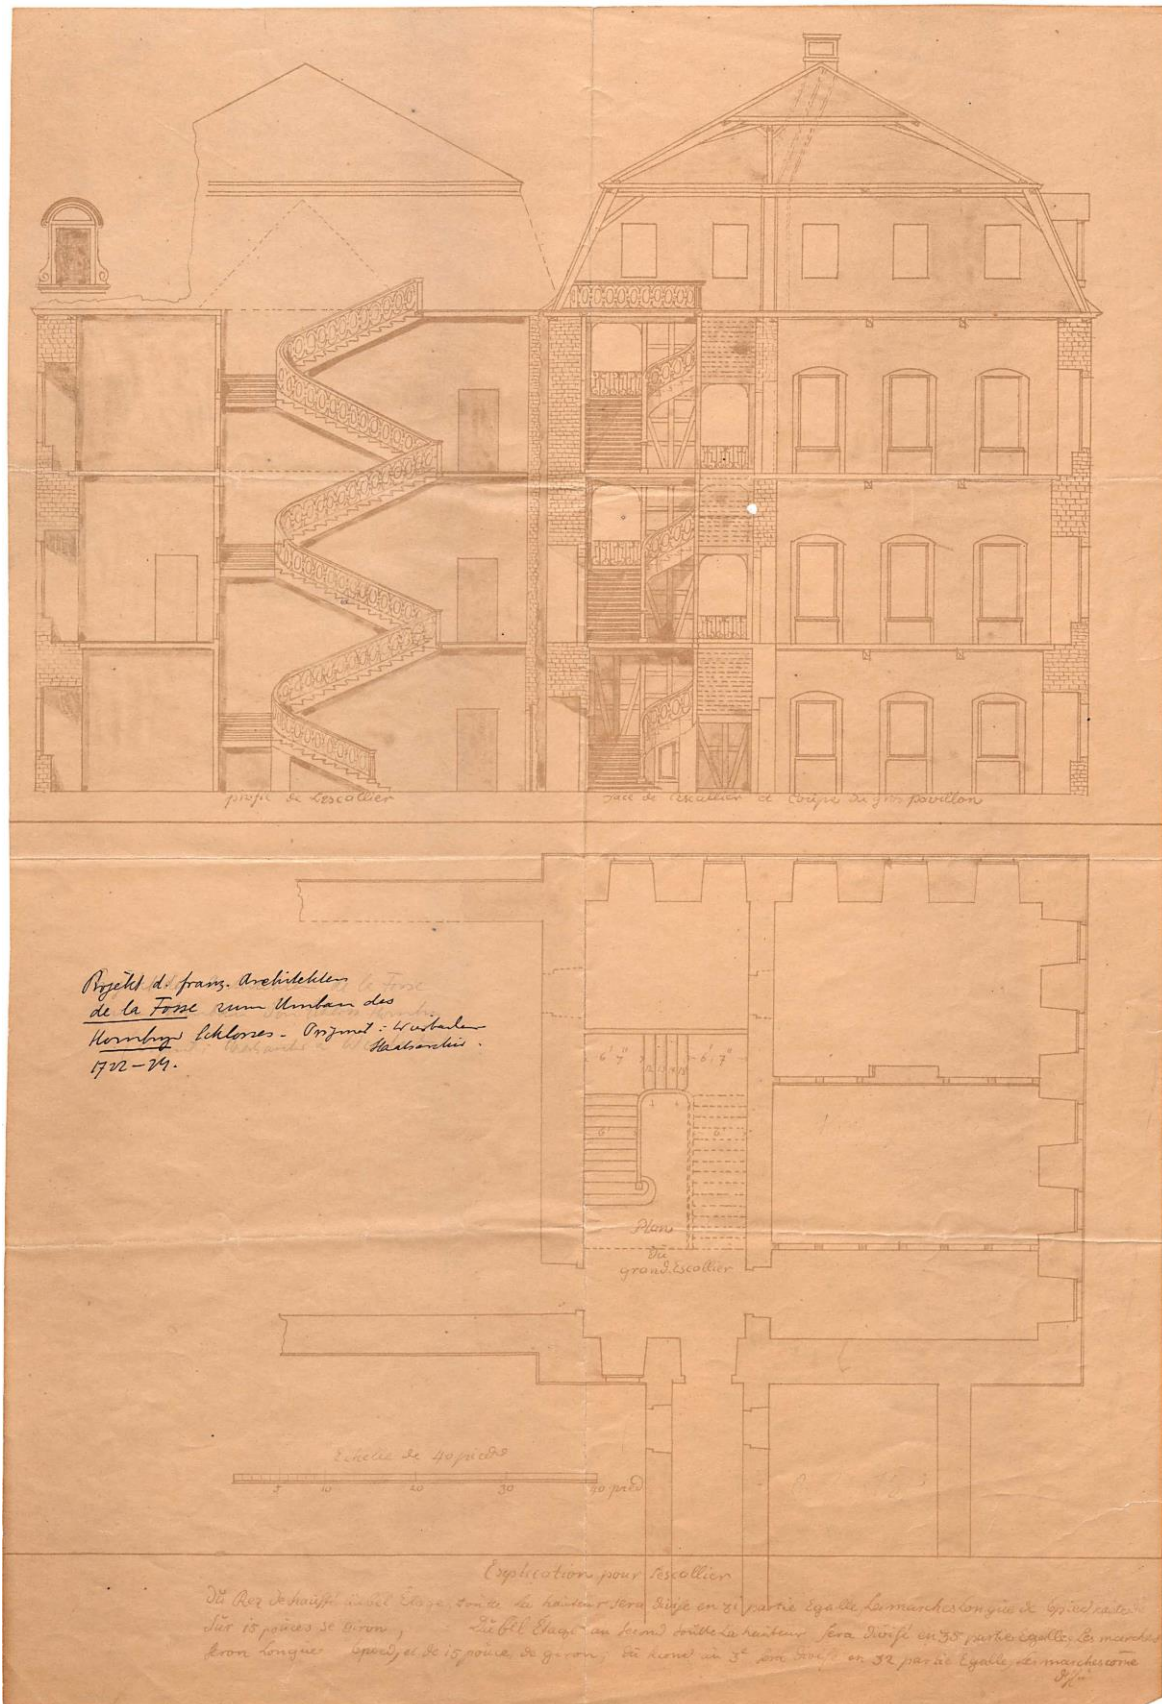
„Projekt des franz. Architekten de la Fosse zum Umbau des Homburger Schlosses. 1722-24“ „Eseptecation pour Escallier“ (Grundriss und Schnitt des Treppenhauses), Staatsarchiv Wiesbaden
